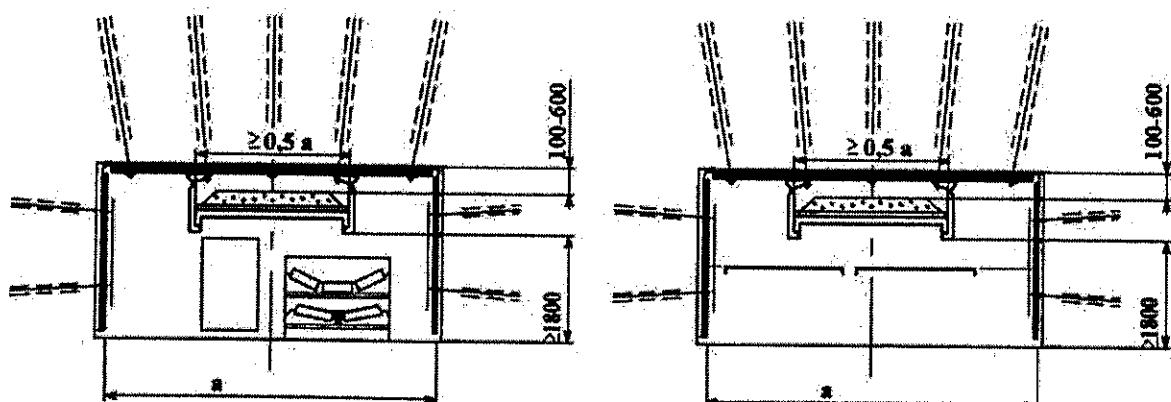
Схема установки сланцевых заслонов в выработках, закрепленных анкерами
